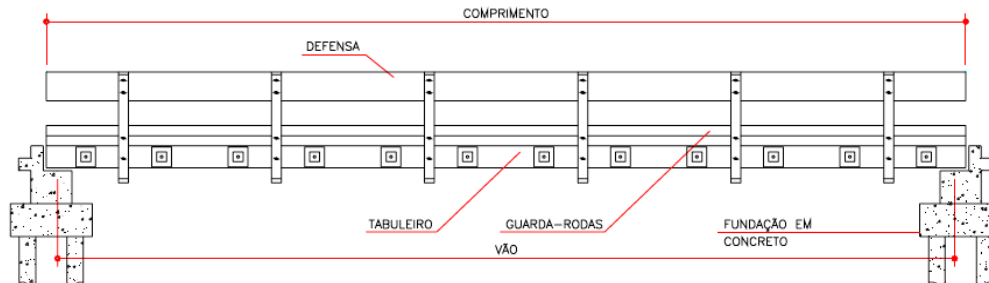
Exemplo de vista lateral da ponte em placa protendida transversalmente
